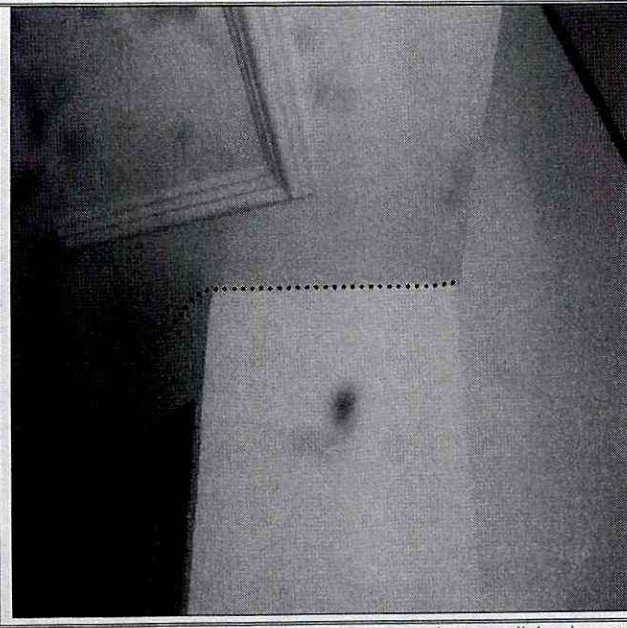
Fisuras en muros de cerramiento y divisorios en las viviendas 29 y 30 del conjunto residencial Plazuelas de Iberia 2, en el Sector Catastral Prado Veraniego Norte de la Localidad Suba.
